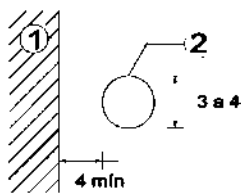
(1).Paramento sólido. (2) Barra de apoyo.
